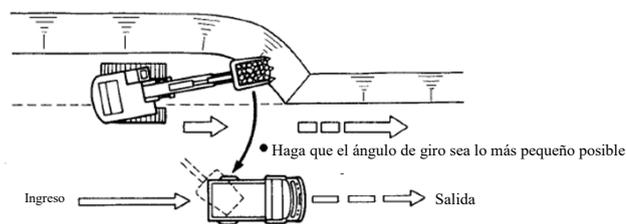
Ejemplo de trabajo de excavación traslacional
